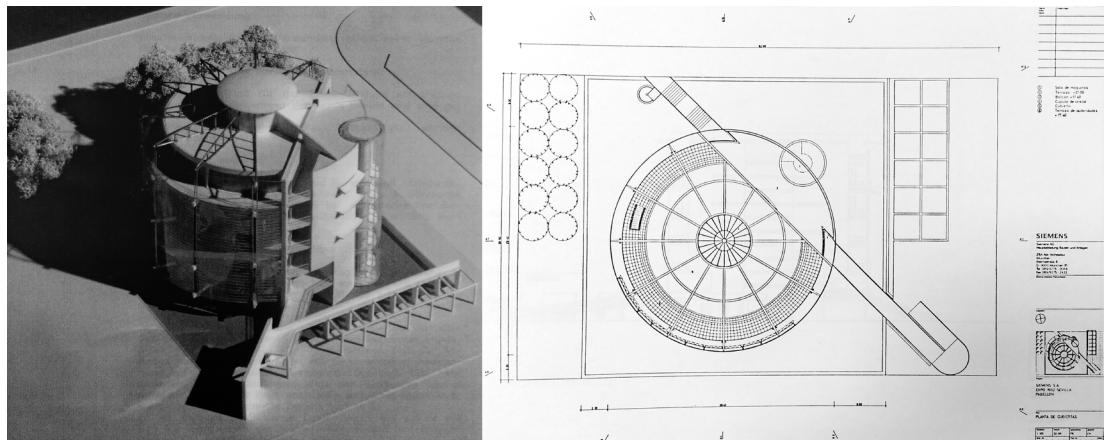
Izq.: Fotografía de la maqueta del Pabellón Siemens. Dcha.: Planta cubierta.
